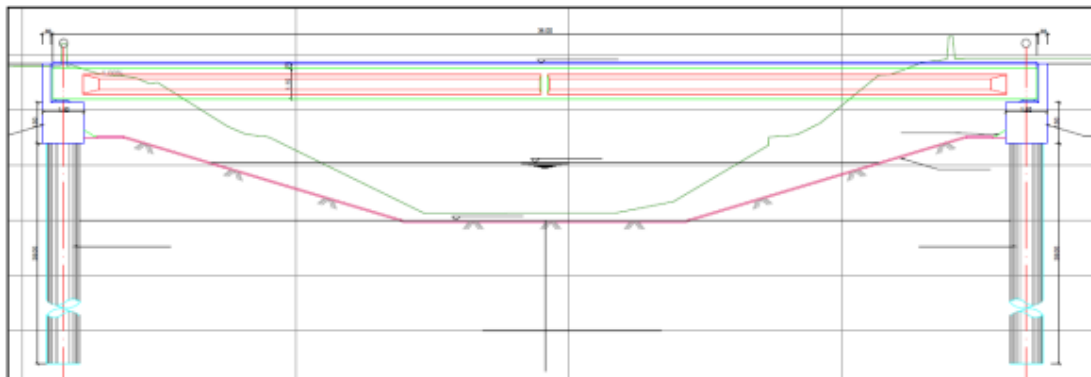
Perfil longitudinal puente peatonal costado sur.
